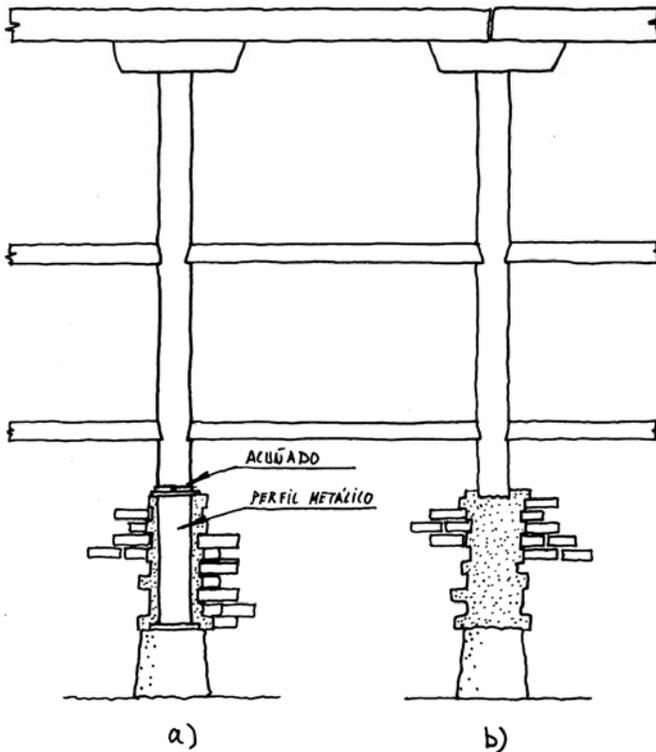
Recalce de un pie derecho con: a) perfiles metálicos, b) hormigón.
